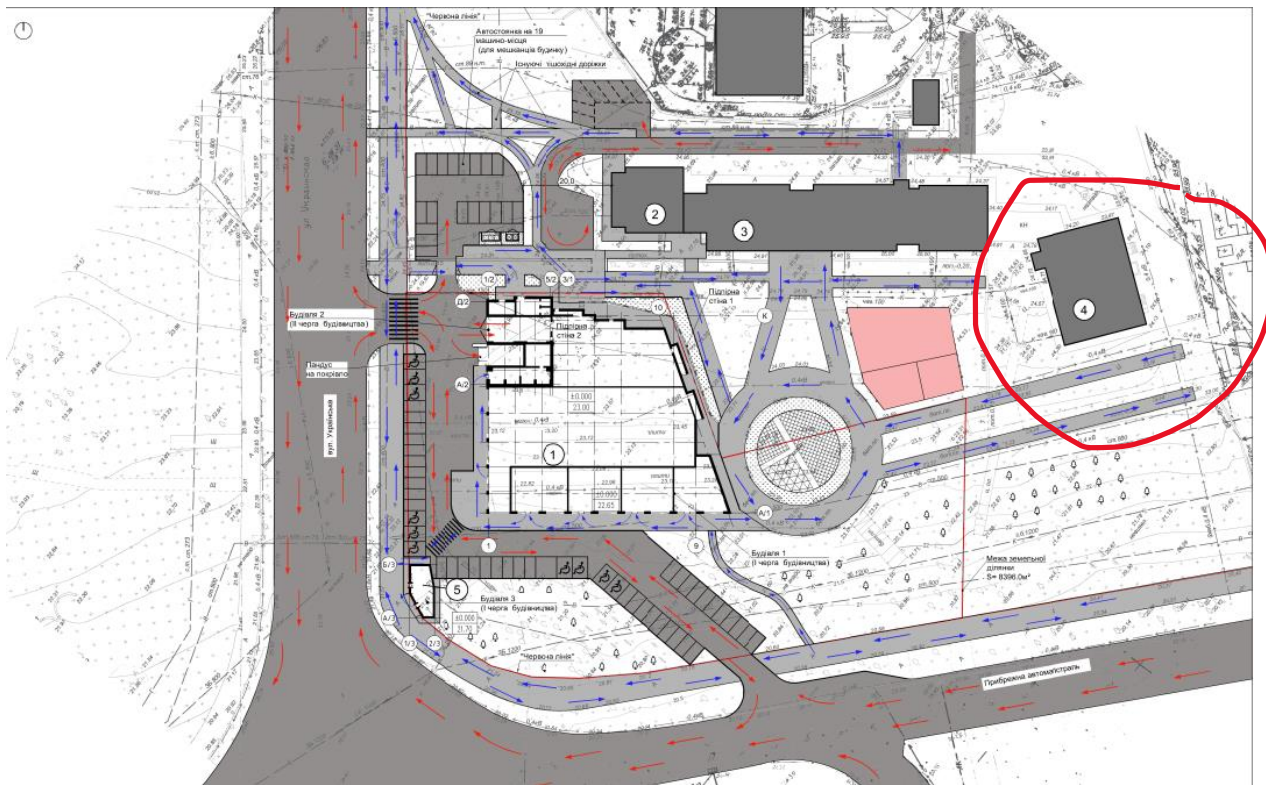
Будгенплан існуючої багатоповерхової житлової будівлі в умовах щільної міської забудови. Будинок під номером 4, наш приклад
